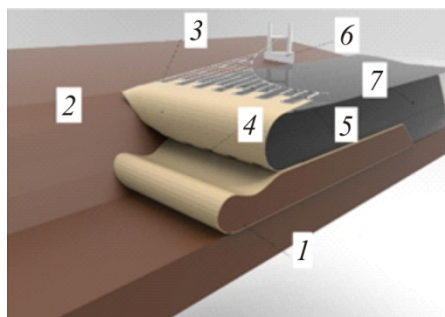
Регулируемая плотина с водовыпускными окнами: 1 – грунтонаполняемое основание; 2 – водоподпорное полотно (мембрана) из композитных наноматериалов; 3 – верхние водовыпускные окна; 4 – нижние водовыпускные окна; 5 – узел крепления (русловой анкер) мембраны к грунтонаполняемому основанию; 6 – береговая анкерная опора; 7 – водный поток
